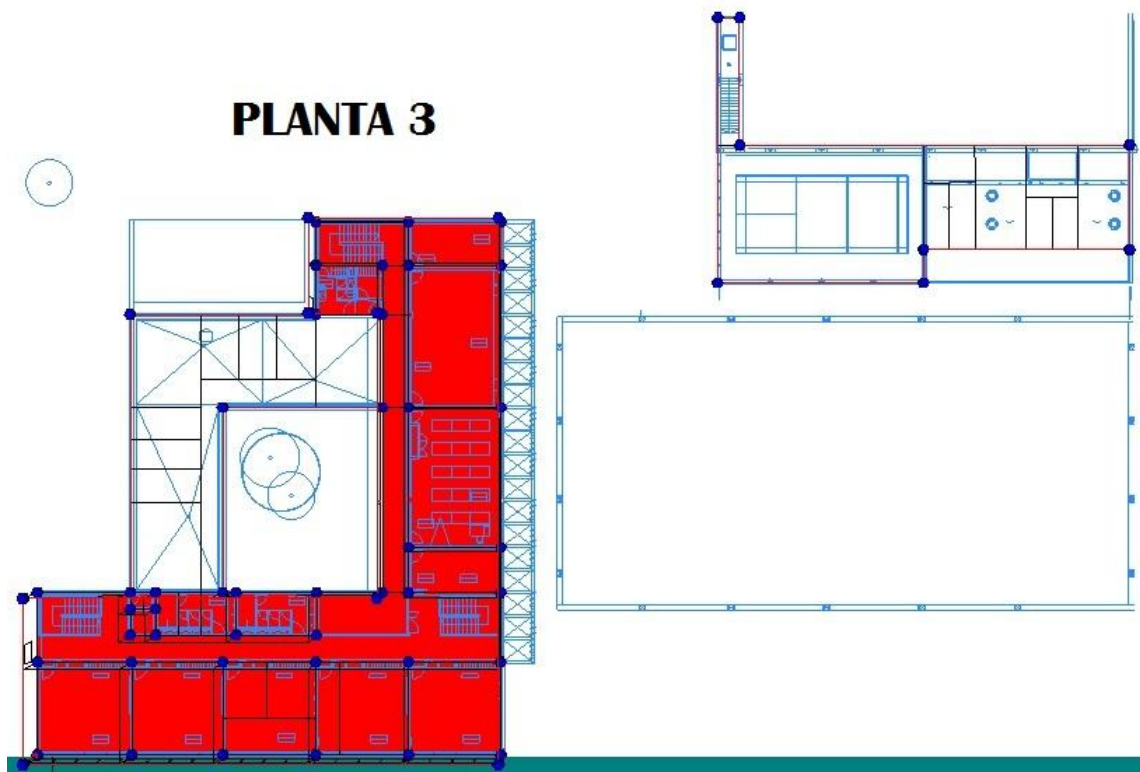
Planta 3 seleccionada en el plano de la 1ª Planta.
